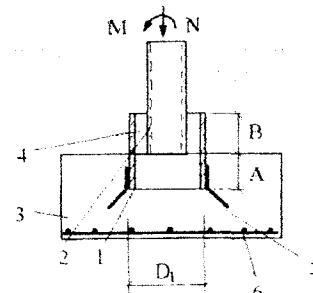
Вузол з'єднання трубобетонної колони з монолітним трубобетонним фундаментом: 1 – з'єднуючий виступ; 2 – трубобетонна колона; 3 – залізобетонний фундамент; 4 – бетон замонолічування; 5 – анкерні арматурні стержні; 6 – арматурний каркас фундаменту
